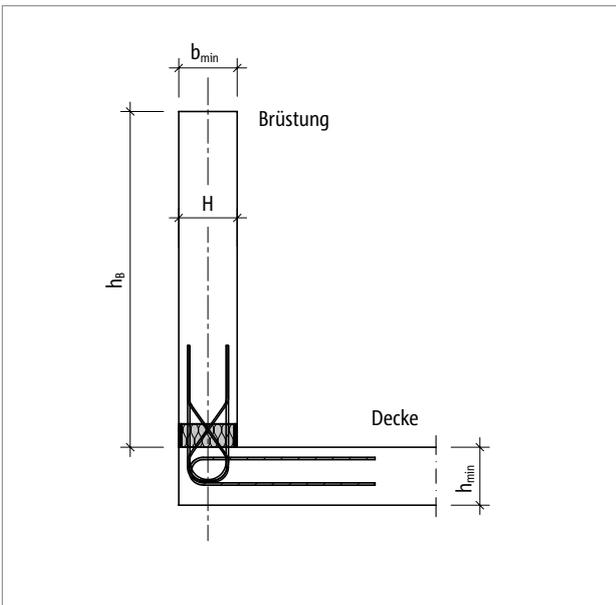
Schöck Isokorb® T Typ AP: Statisches System Brüstungshöhe h_B ; Isokorb® Höhe H
